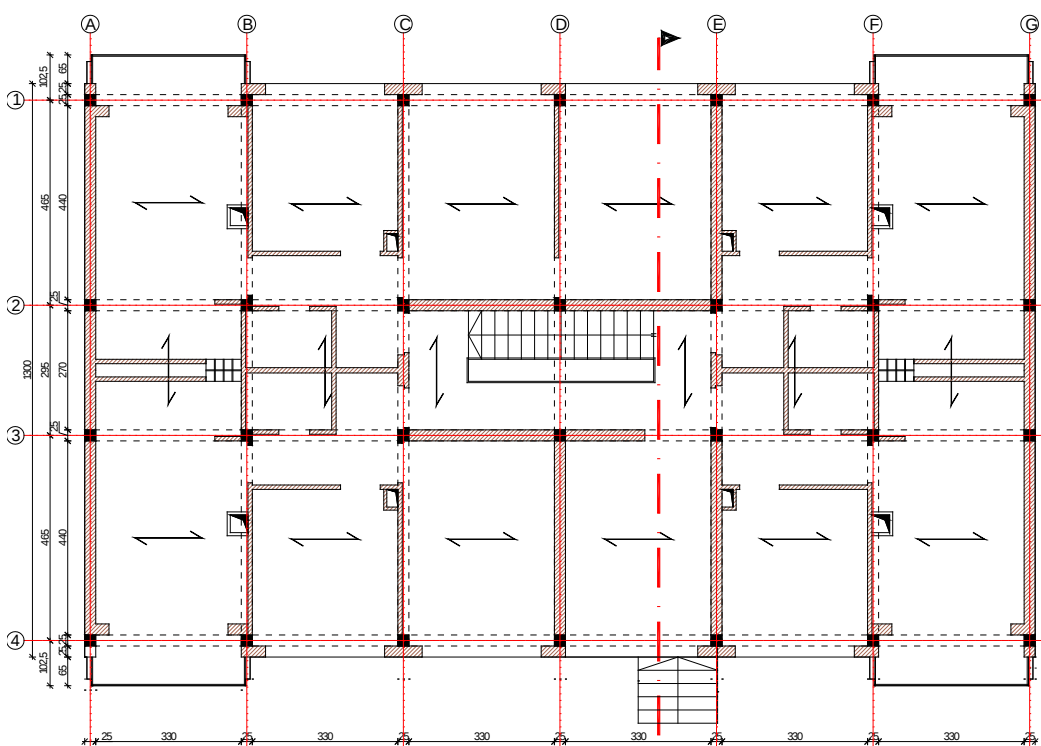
Planimetria e katit karakteristik të ndërtesës A7, M4H – Muraturë me kufizime BA
